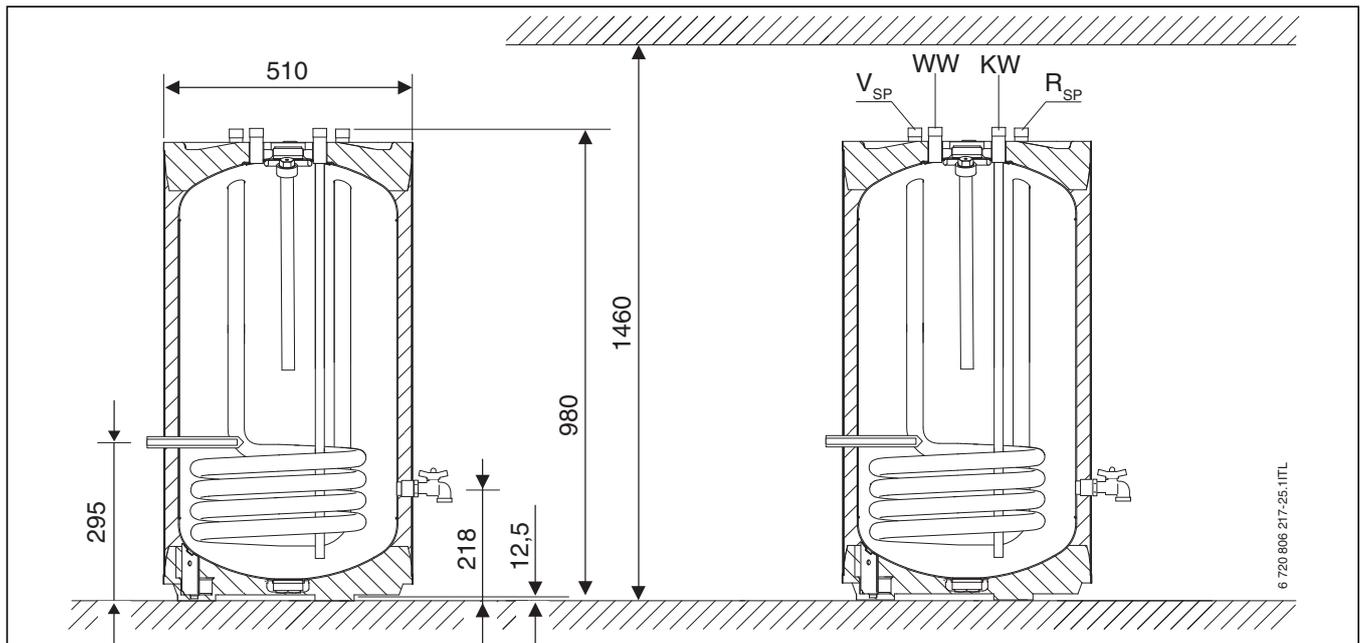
Bau- und Anschlussmaße ST 120-5 Z
